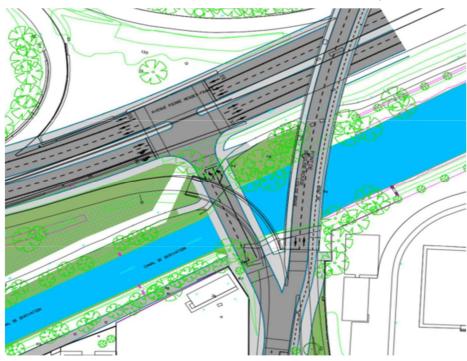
Vue en plan du futur carrefour Eglise Rouge (source : AVP 2023, GETAS)
